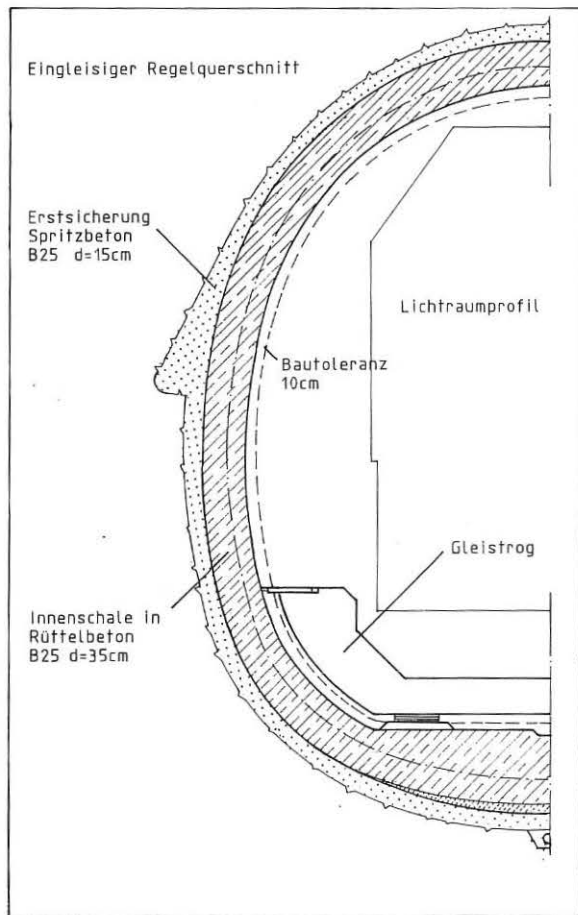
Konventionelle Spritzbetonbauweise mit nachträglich eingebauter Rüttelbetoninnenschale ohne Isolierung.
